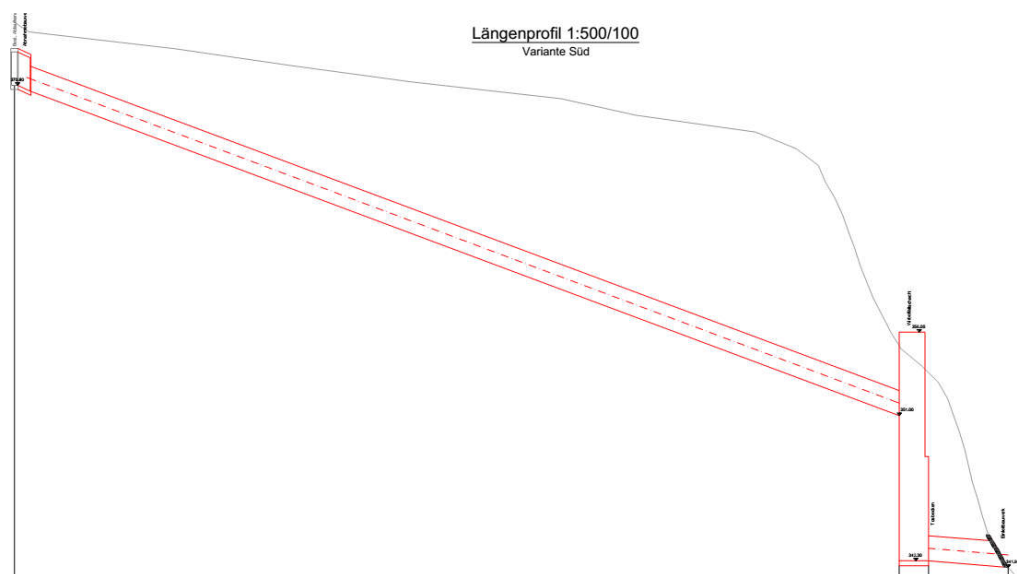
Auszug Plan 102 Längenprofil Variante Süd
